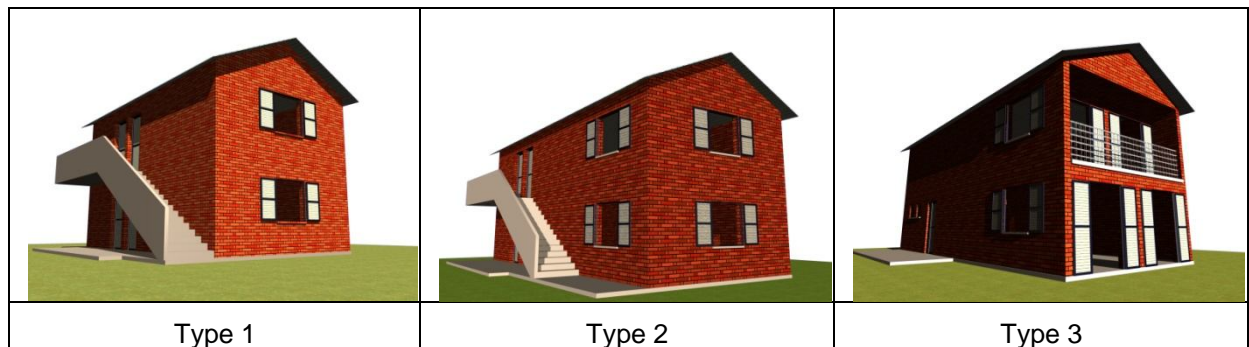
Simulation de l'aménagement du site de Soavimasandro
